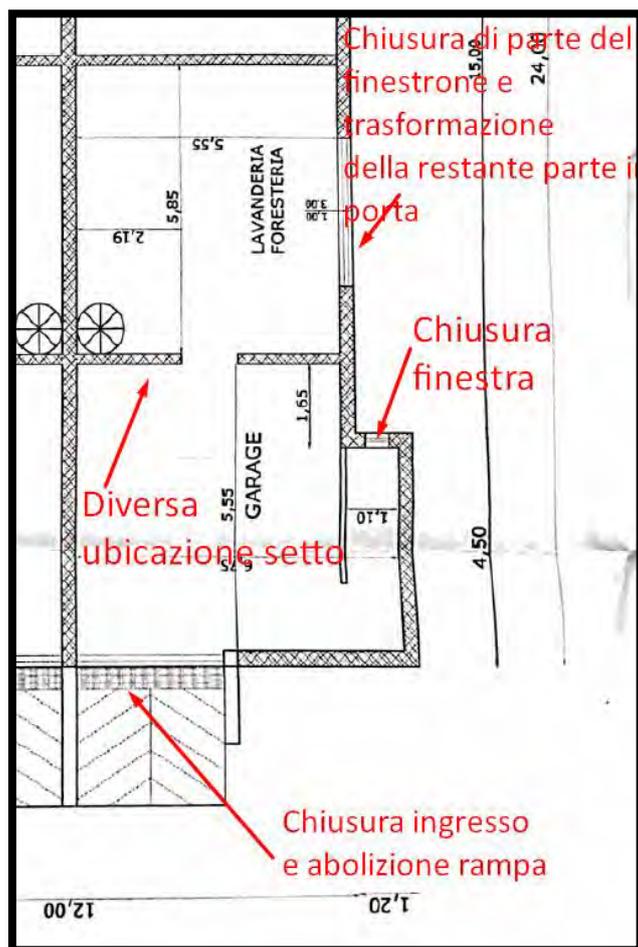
Pianta piano terra allegata alla CILA prat. n. 294/2011
